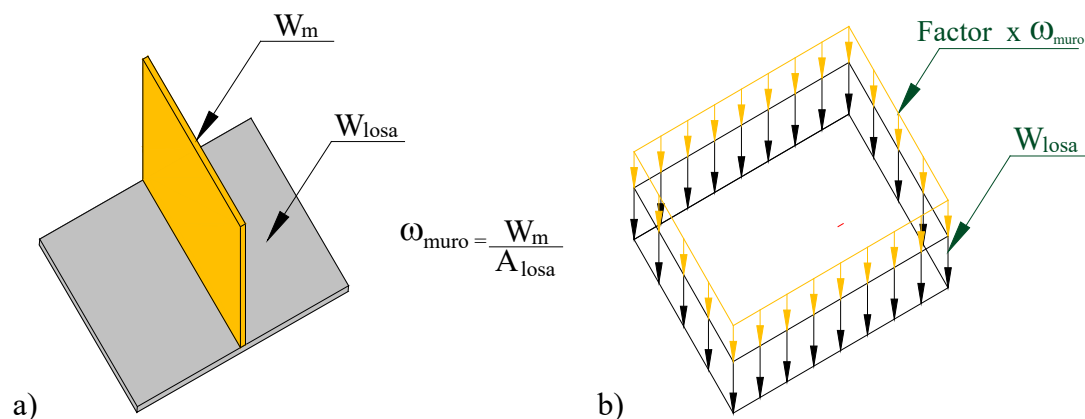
Modelo de losa con carga: a) lineal debida a un muro y b) equivalente uniformemente distribuida.
